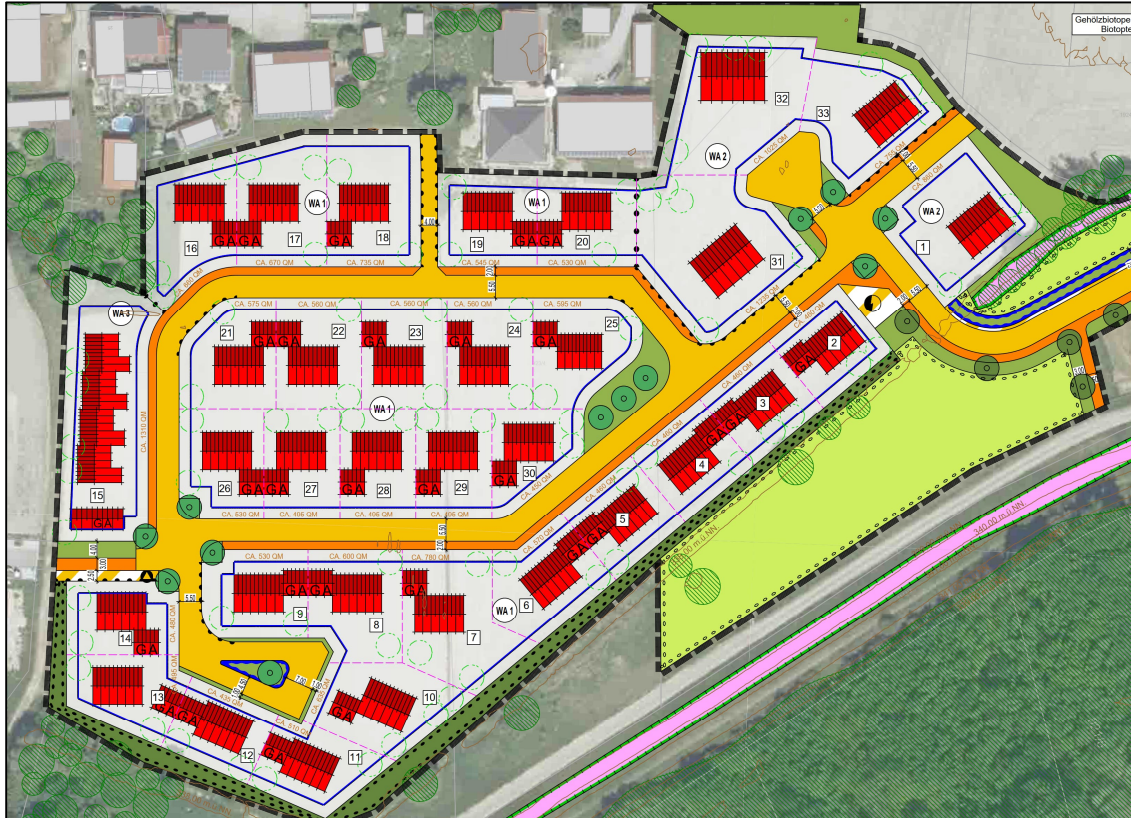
Planzeichnung zum Bebauungsplan "Weindschwaige II" der Stadt Landau a. d. Isar /7/
